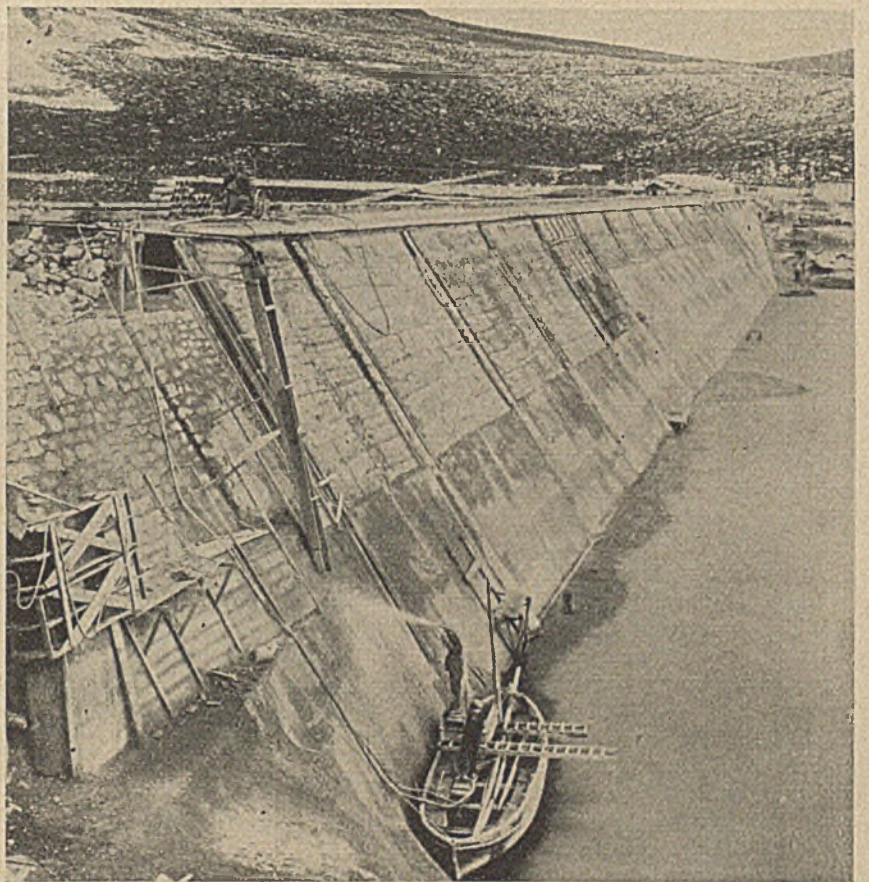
c. Herstellung der Betonhaut (n. Bau).
